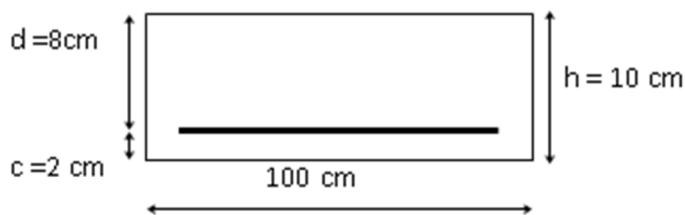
Schéma statique de la section de l'acrotère.
